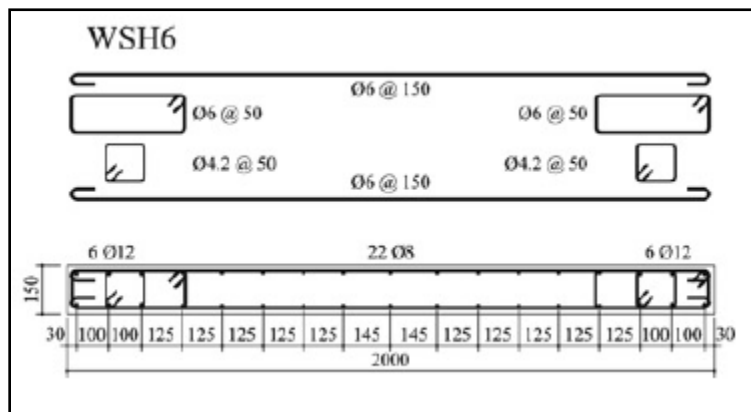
Detalles del armado del muro WSH6 (dimensiones en mm) (desde Dazio et al. [36]).
